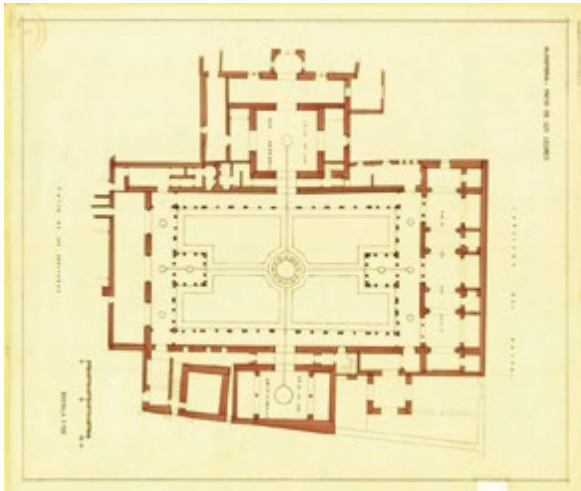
Planta del Palacio de los Leones (Archivo Junta de Andalucía)
